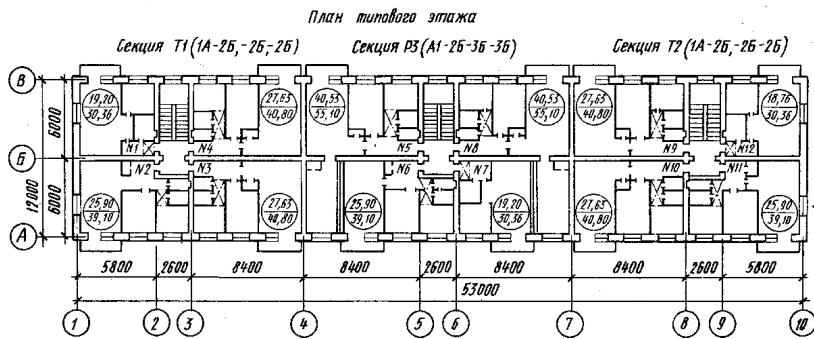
План типового этажа пятиэтажного жилого дома
